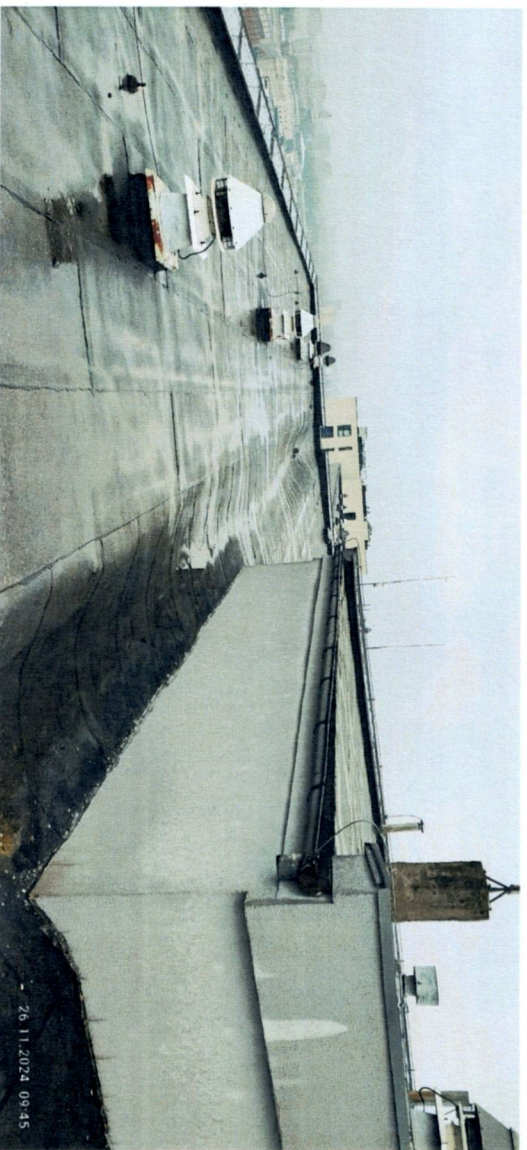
Widok dachu (stan pokrycia; widok koryta odwadniającego)
